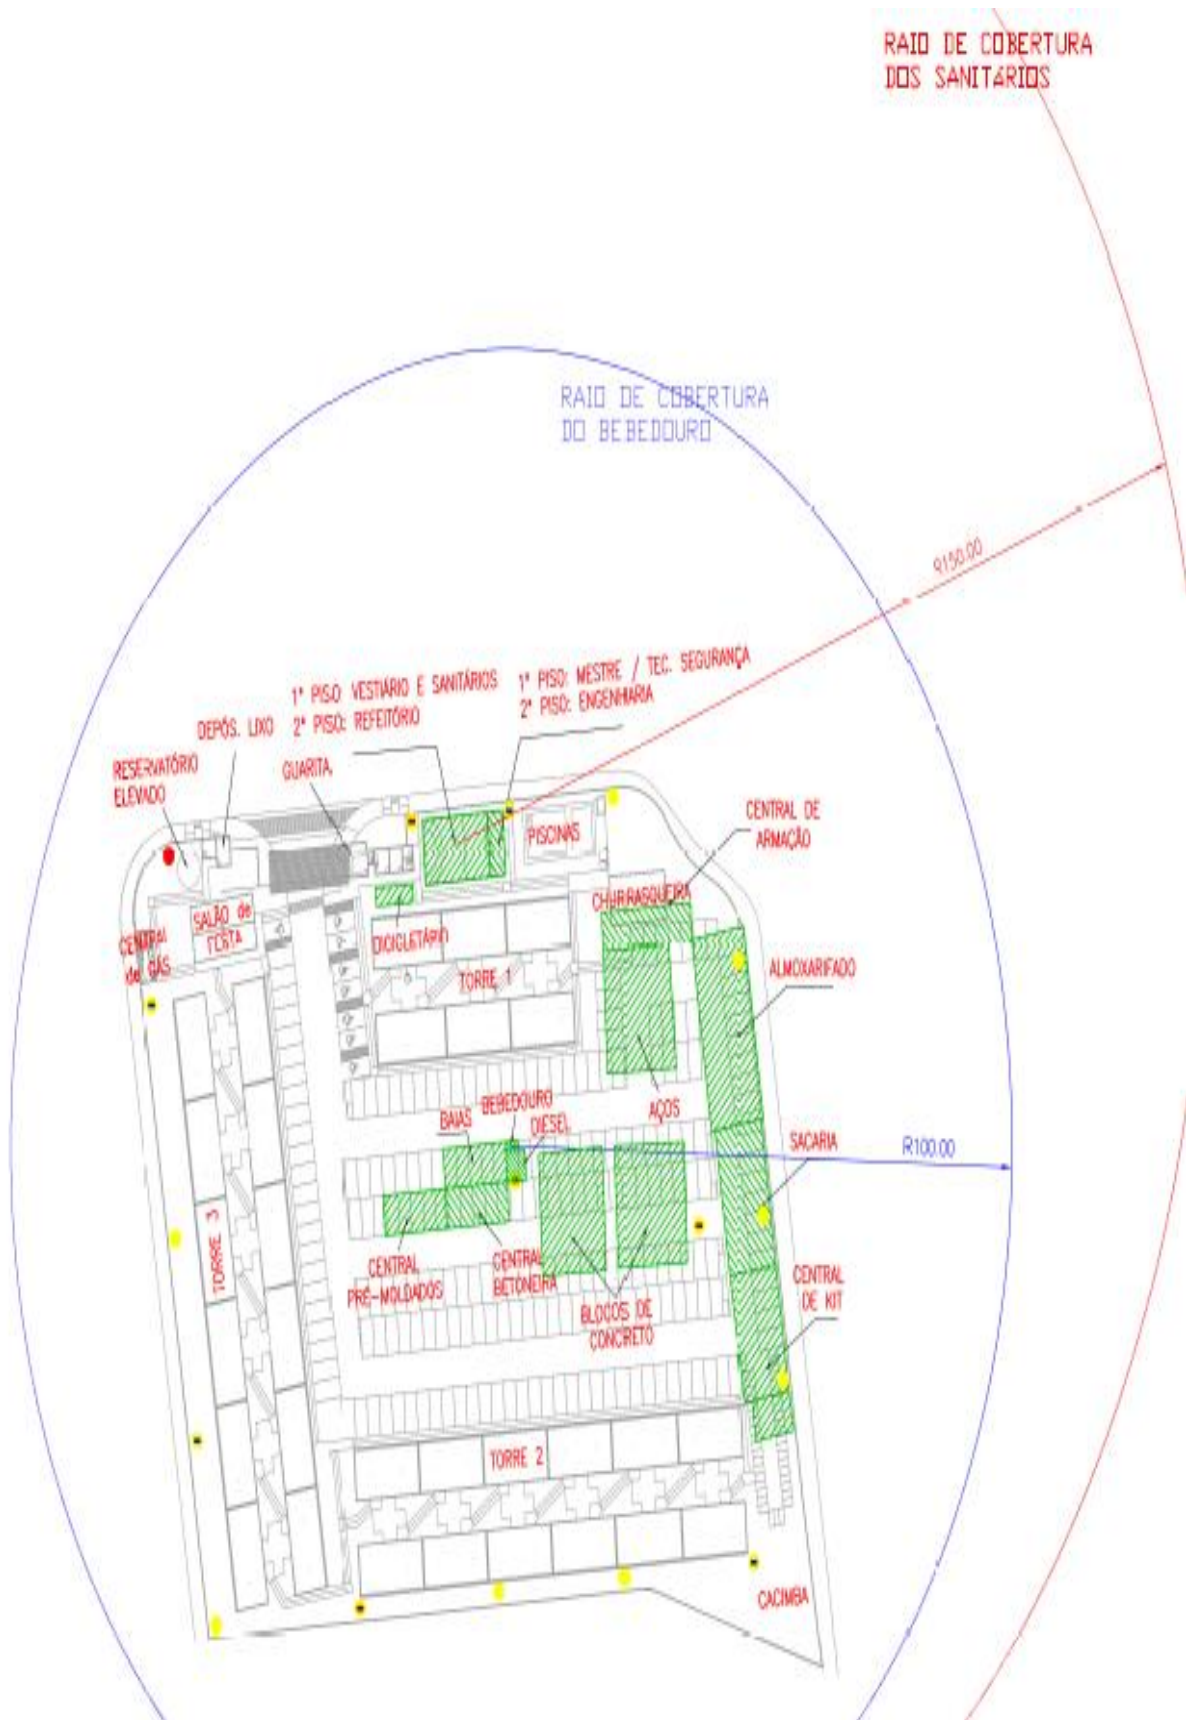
Partes fundamentais do layout do projeto de canteiro da obra 1 (Fonte: o pesquisador, 2019)
